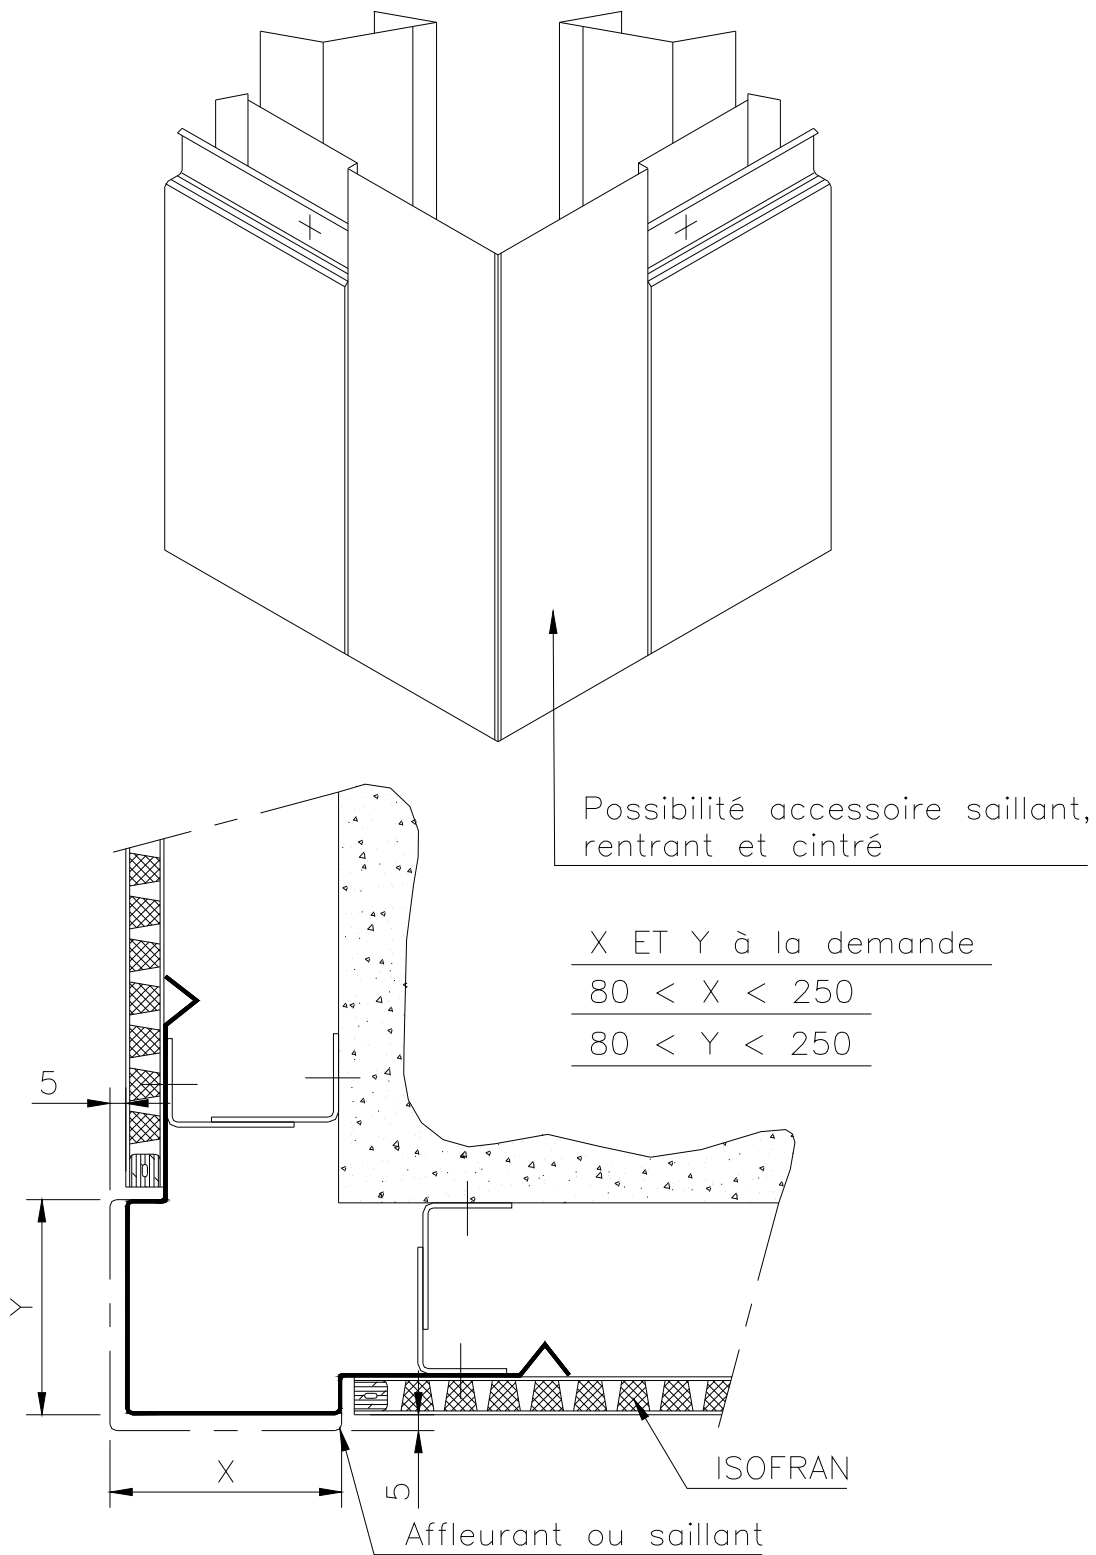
Panneau ISOFRAN Pose horizontale - Accessoire d'angle (côtes en mm)
